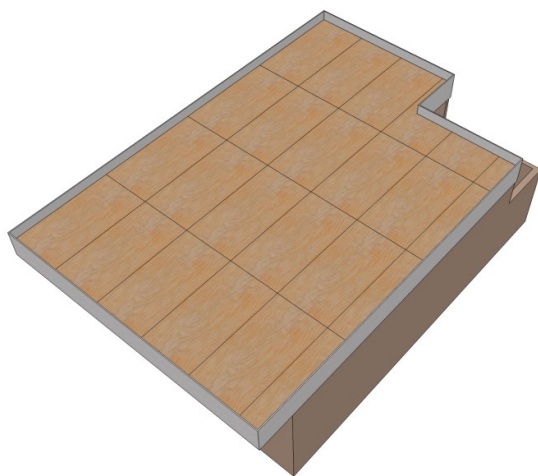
Chapas de compensado e acabamento em placa cimentícia
